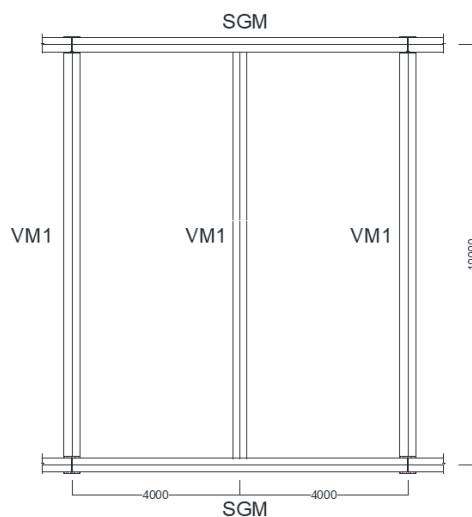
Layout de um pavimento com uso do sistema Stub-Girder modificado
